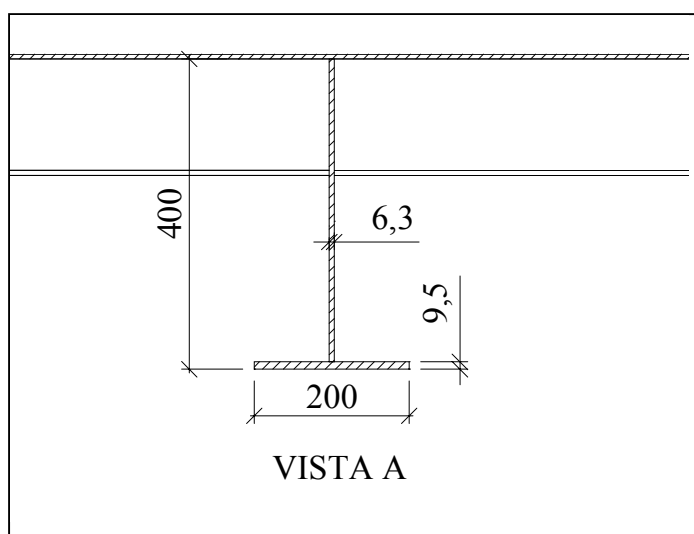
Dimensões das vigas do painel enrijecido - vista A (cotas em milímetros)
